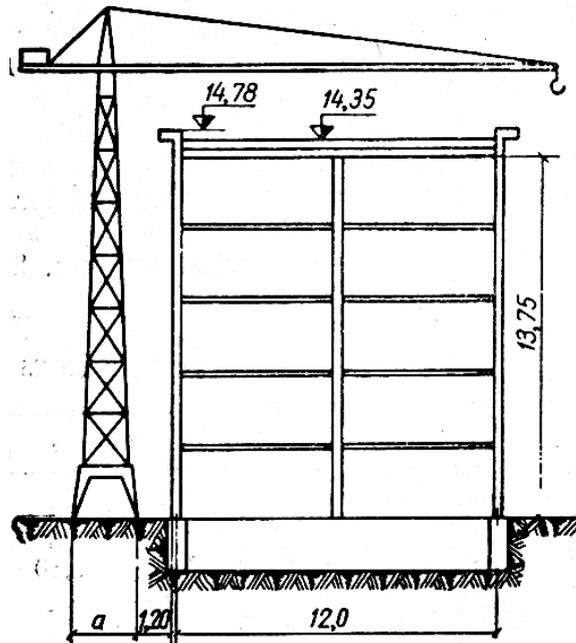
Схема выбора крана и поперечный разрез здания
